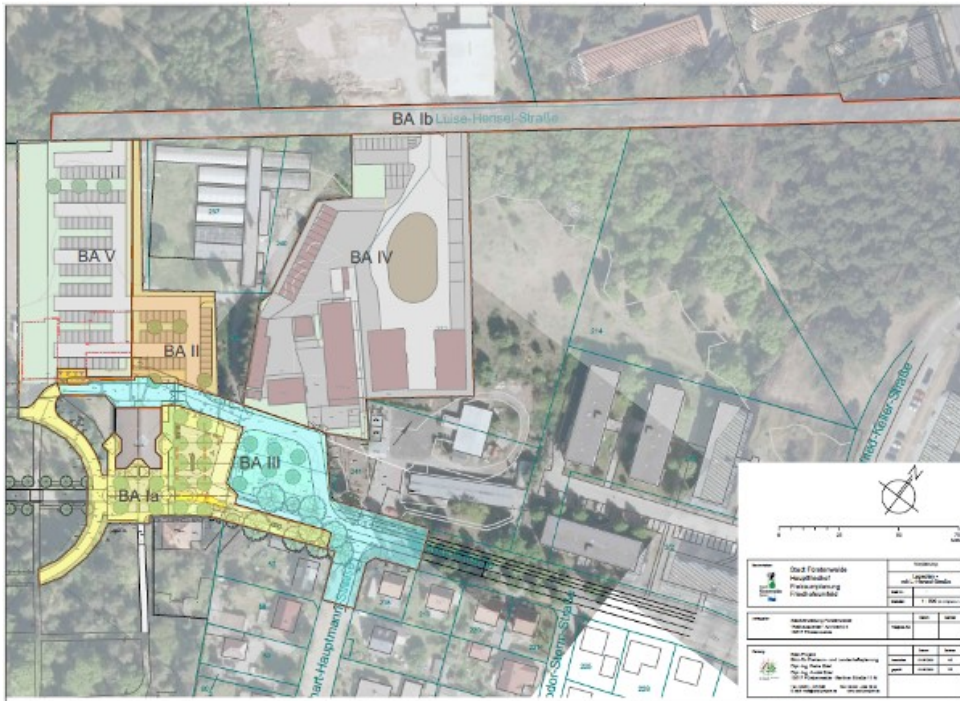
Lageplan mit Darstellung der Bauabschnitte
